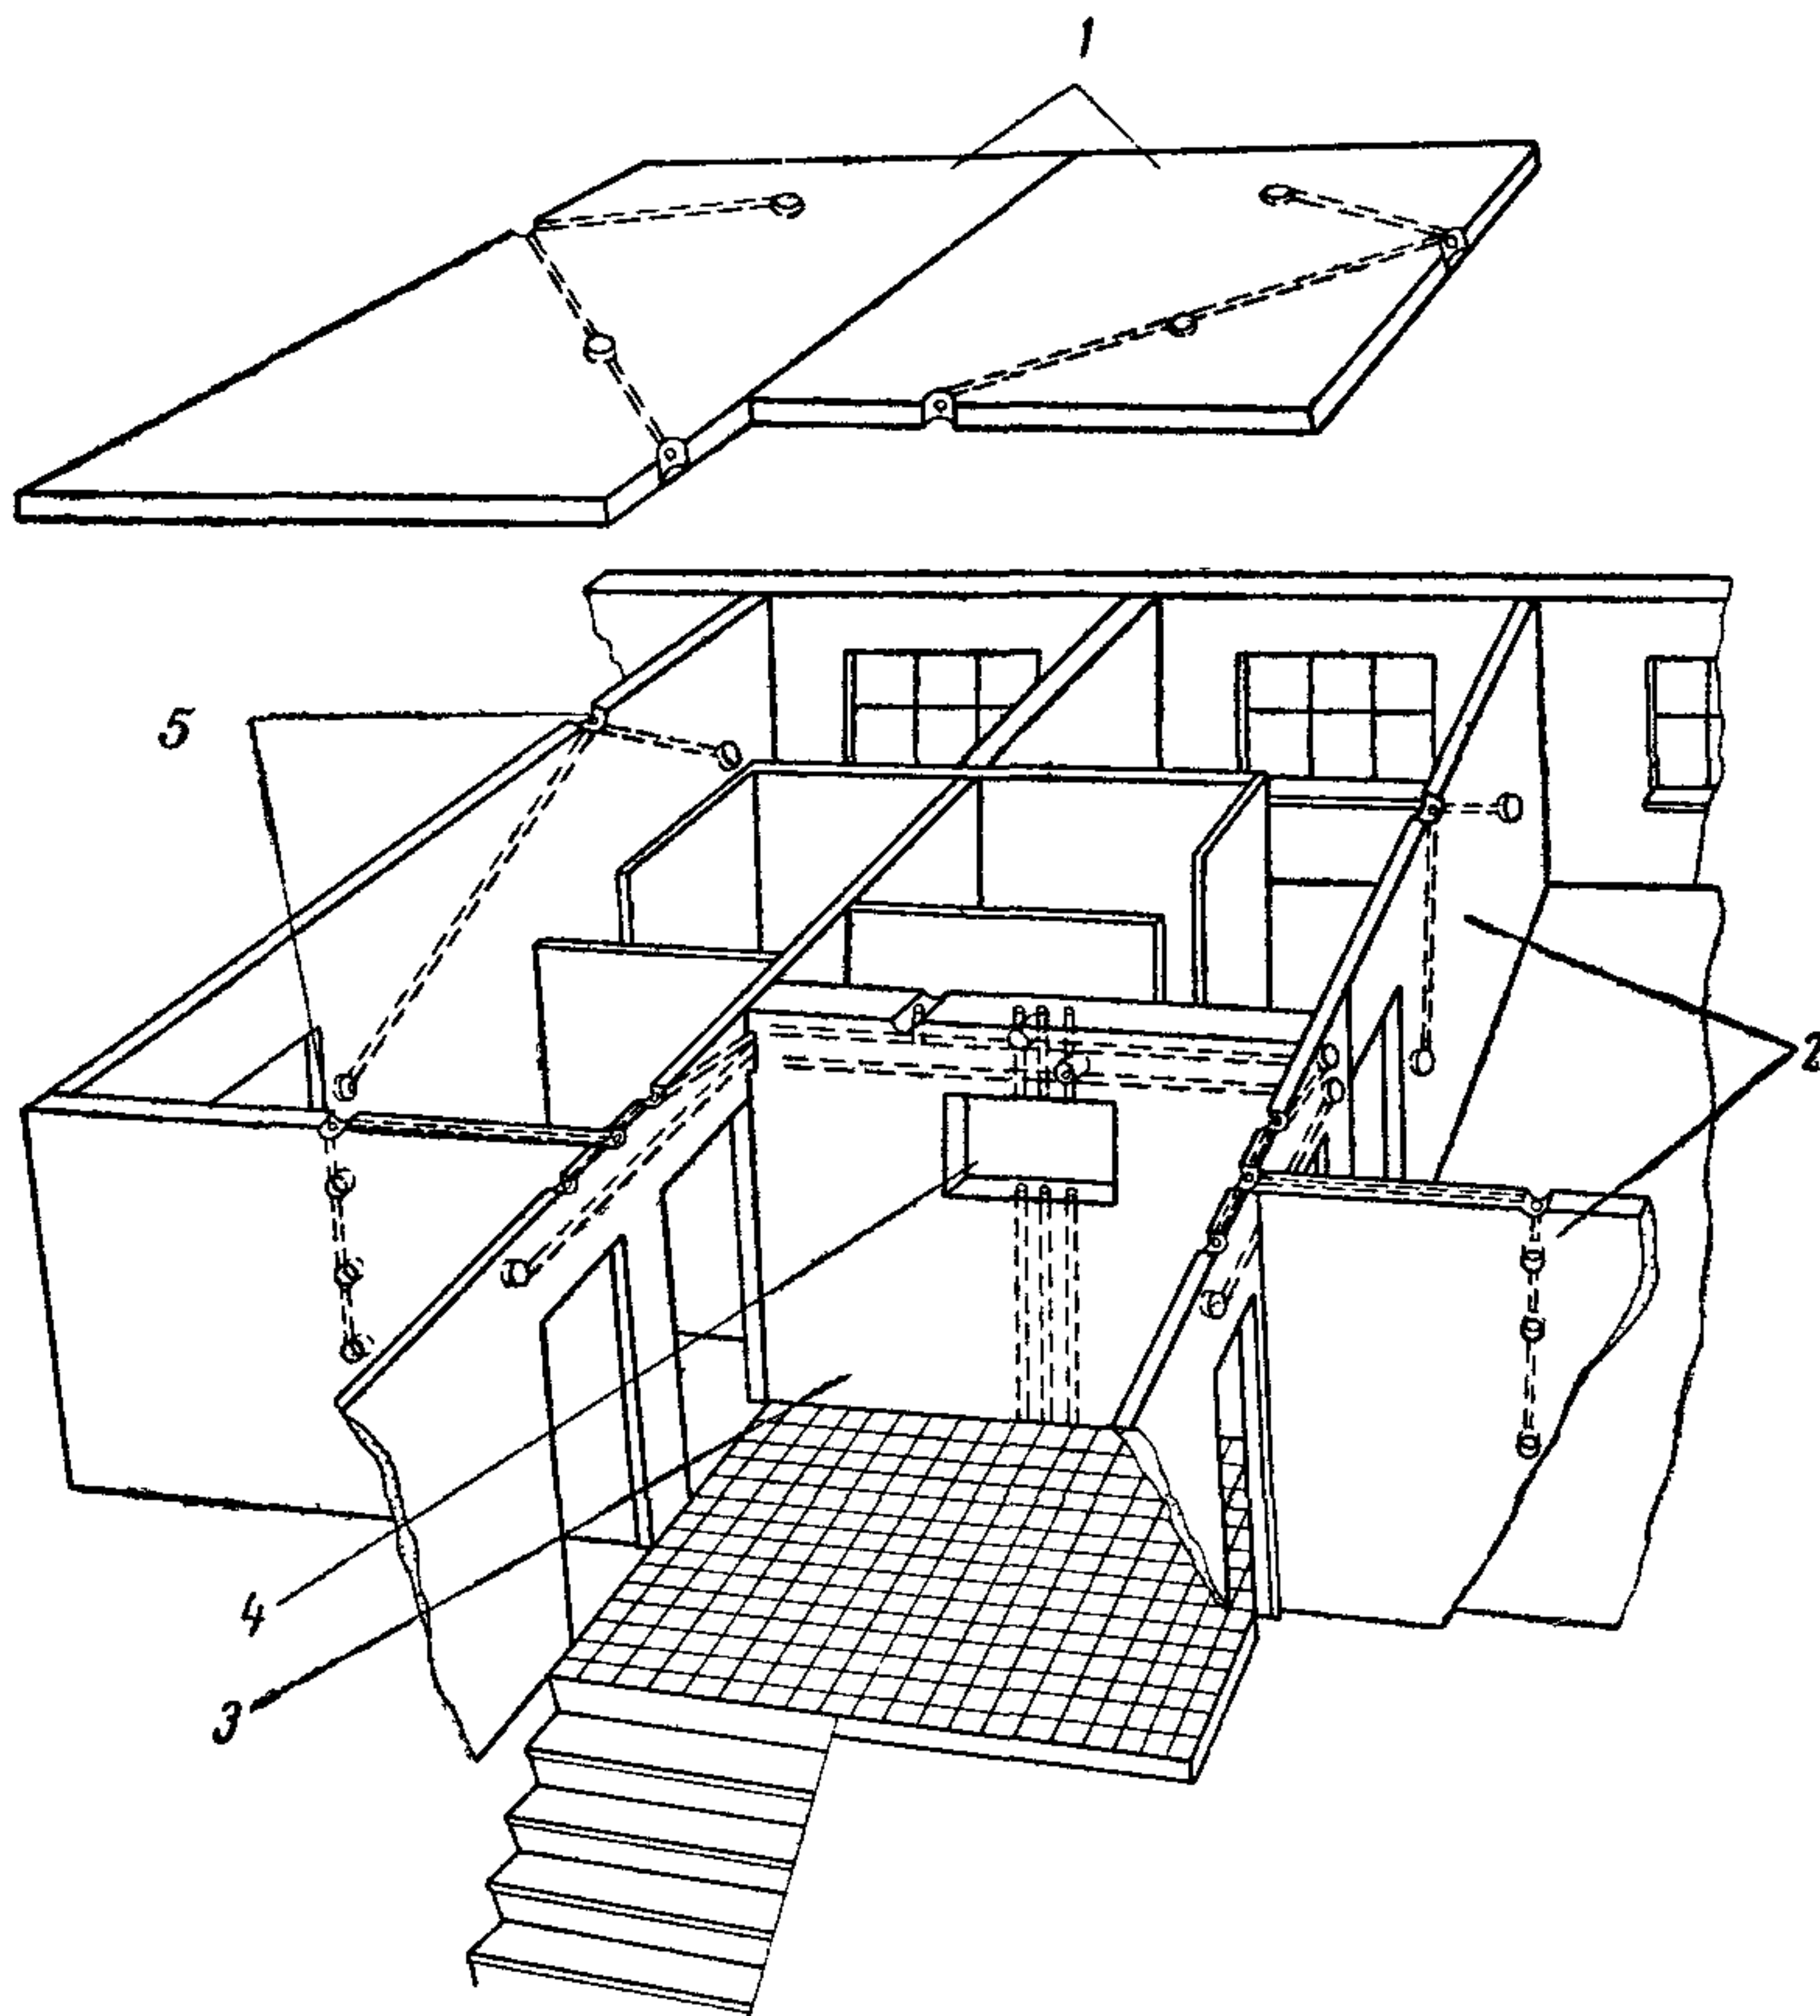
Пример выполнения электропроводки в каналах крупнопанельного жилого дома с монолитными железобетонными панелями (здание серии 1605А)
